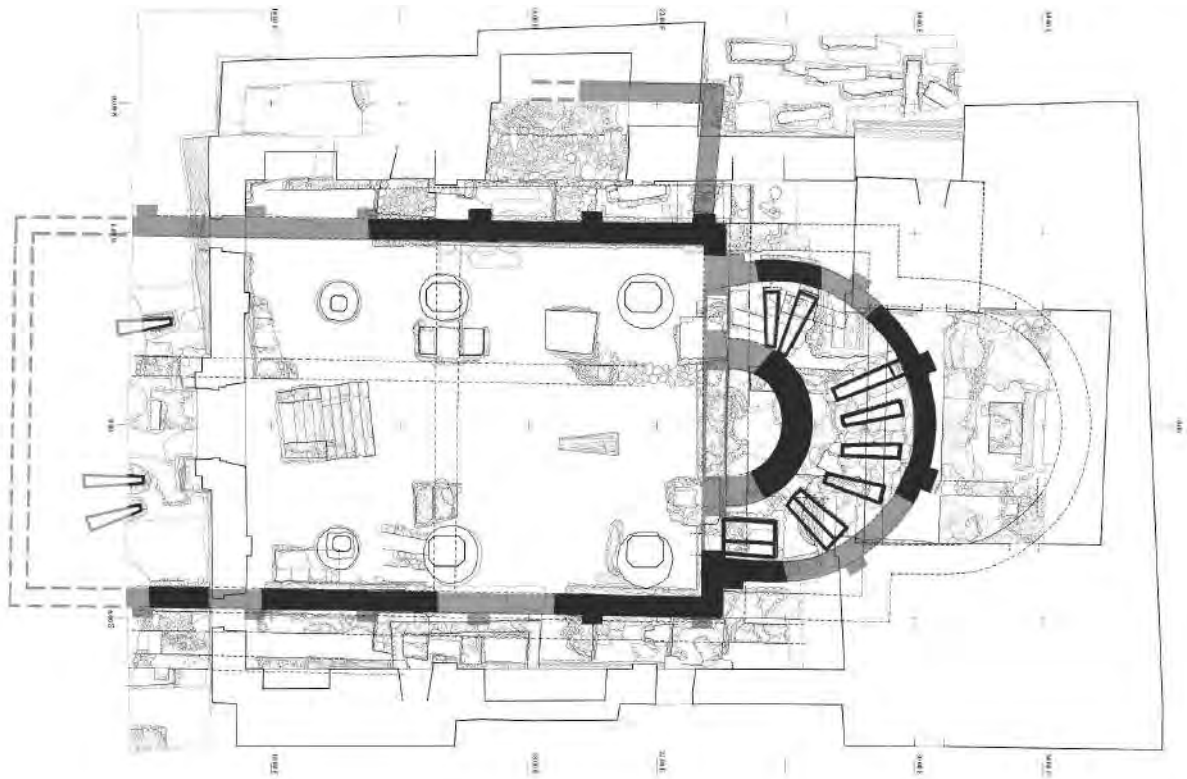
Chiesa S. Stefano: Planimetria fase II.
